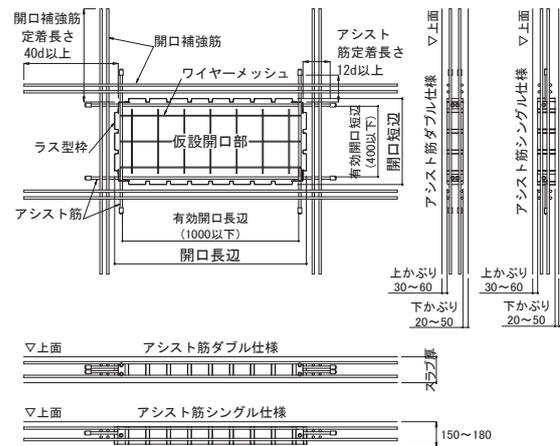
工法概要図 (開口サイズ 1,100 mm × 500 mm)
